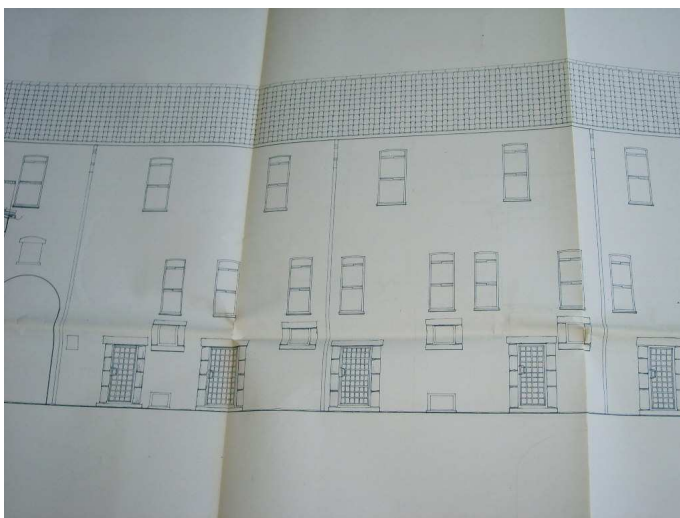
progetto SBAPL -1° cortile corpo est-prospetto (stralcio)
